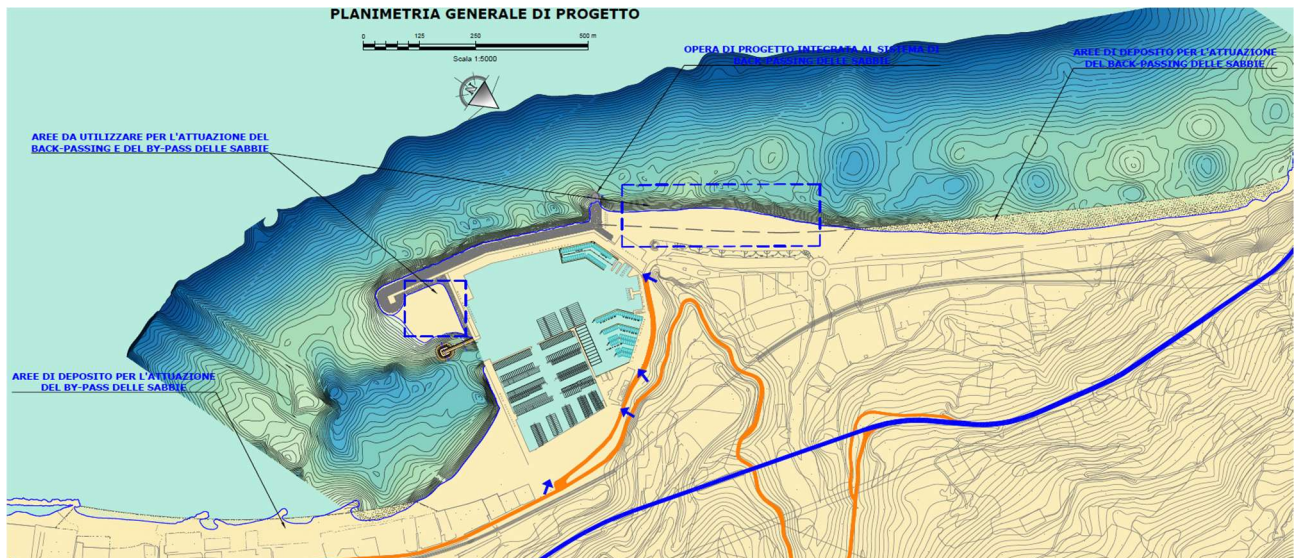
Interventi di progetto - Messa in sicurezza dall'insabbiamento dei fondali dell'imboccatura
